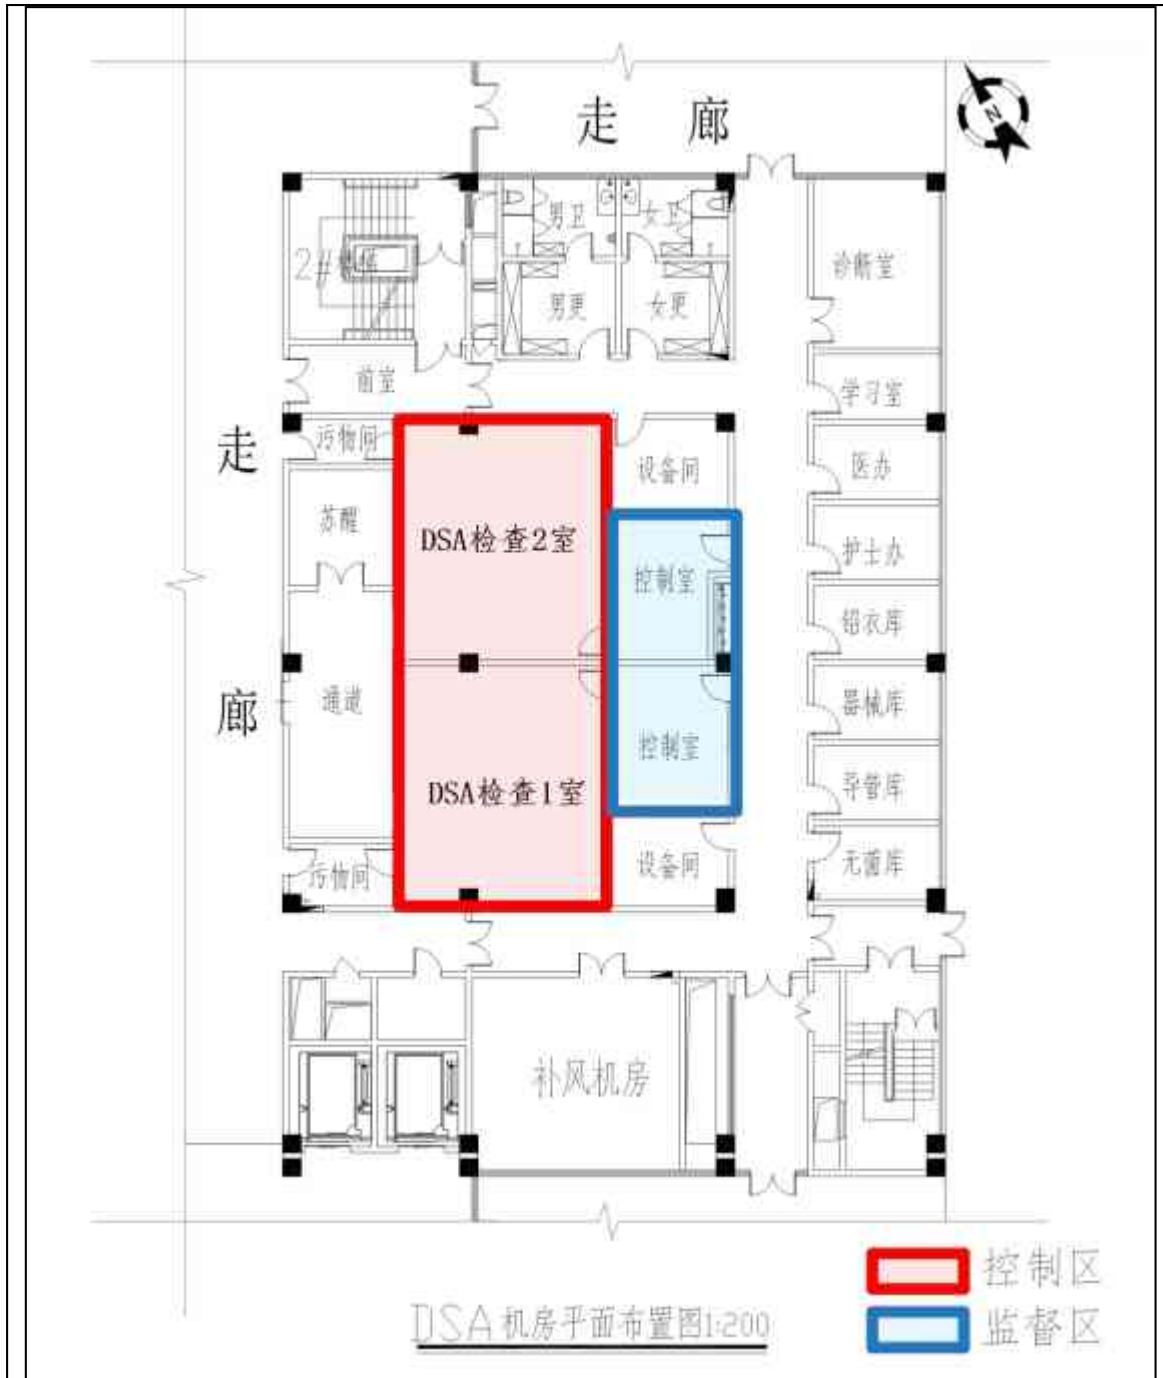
南京市中医院门诊医技楼负一层DSA机房平面布置及分区示意图
